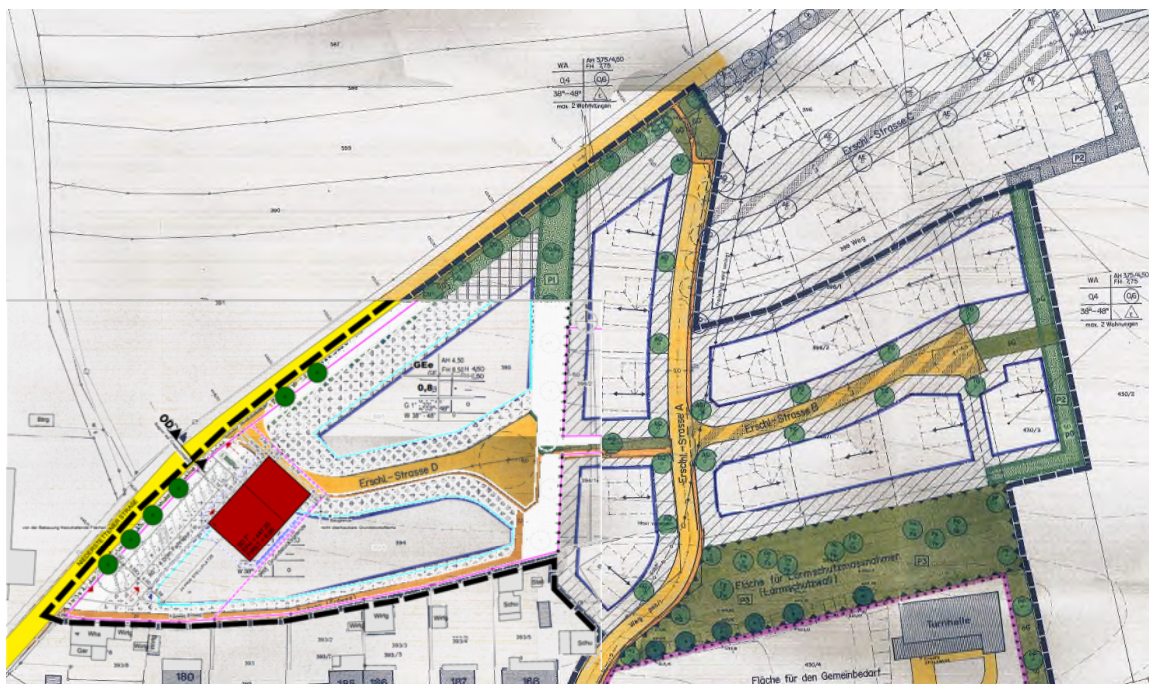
Ausschnitt aus dem Bebauungsplan 'Meisenhof' mit Überlagerung des Lageplans für das Feuerwehhaus [18]
